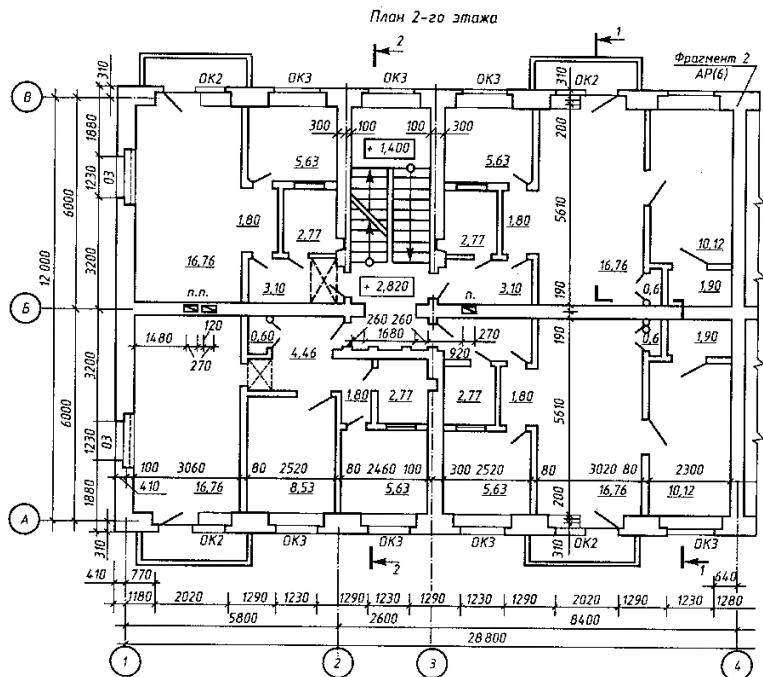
План 2-го этажа многоквартирного жилого дома
